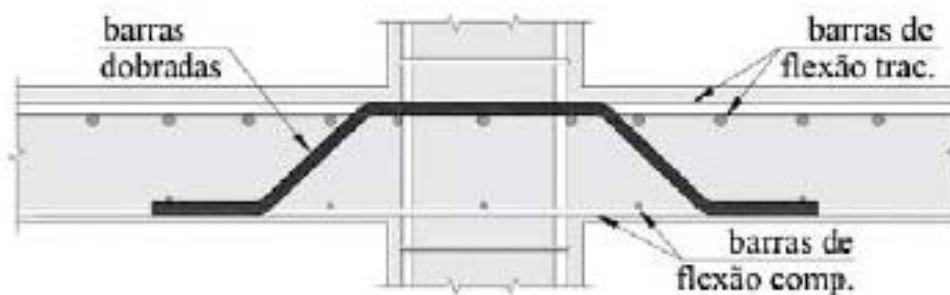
REPRESENTAÇÃO DA ARMADURA TIPO BARRA DOBRADA
